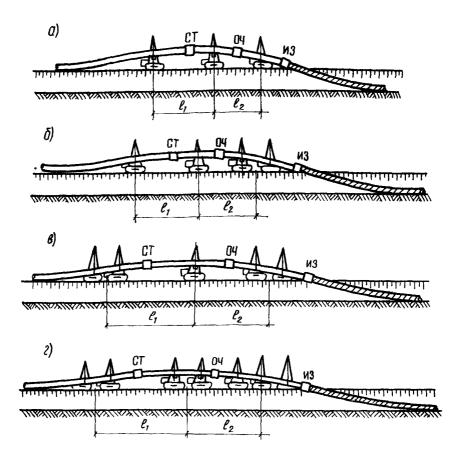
Рис. I. Схемы расположения трубоукладчиков и машин в изоляционно-укладочной колонне при совмещенном способе производства работ для трубопроводов различных диаметров:
